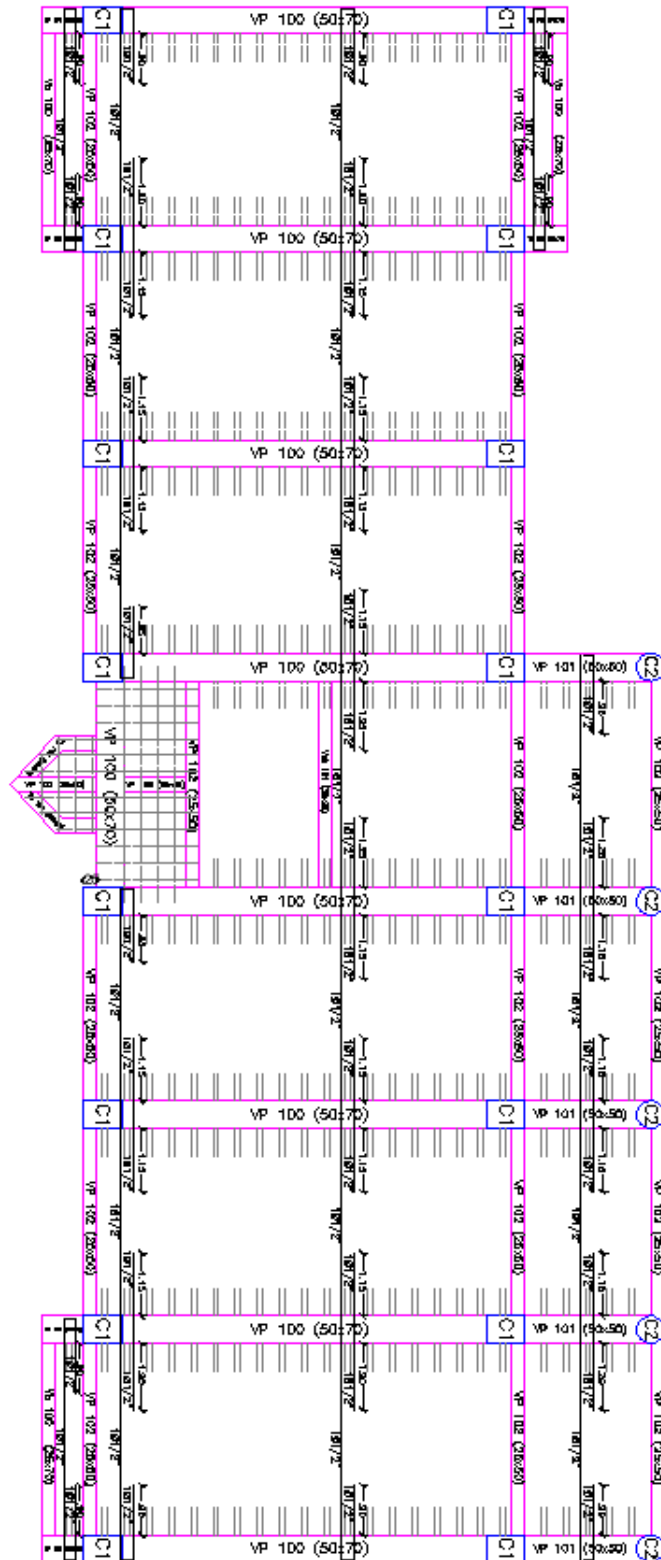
Planta, aligerado 1, NTNT: +3.65.
